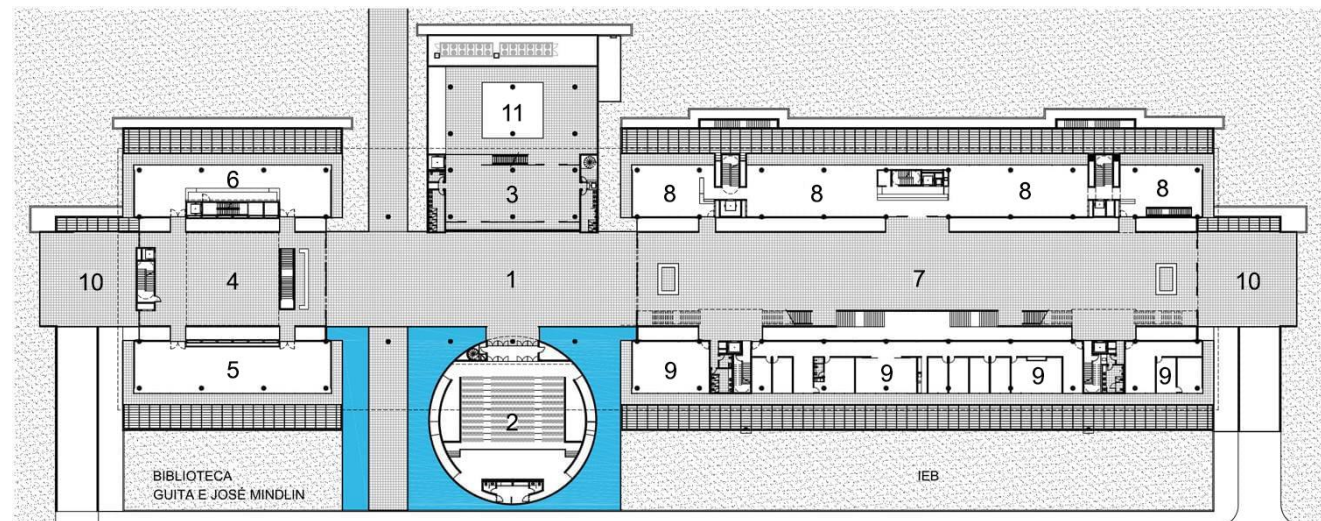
Planta baixa térreo. Fonte: Archdaily (2019c).
